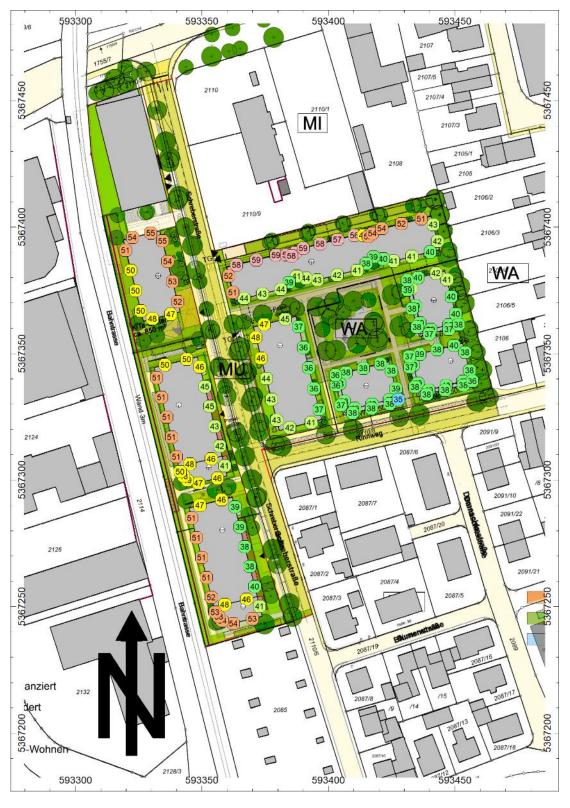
Lageplan mit Darstellung der höchsten Beurteilungspegel über alle Geschosse entlang der Fassaden der im Plangebiet vorgesehen Bebauung am Tag mit Haus 3/4
